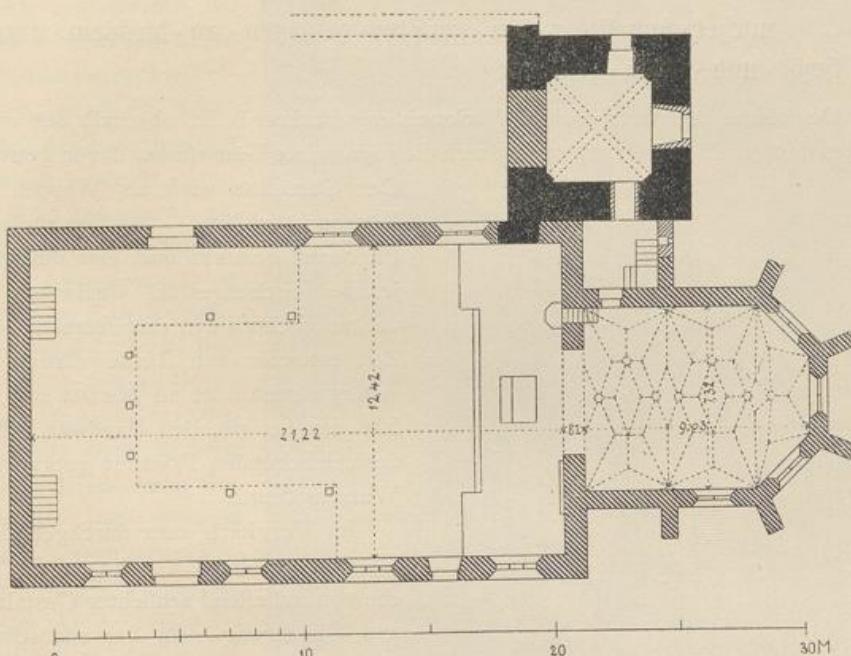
Kürnbach. Grundriss der Pfarrkirche.
